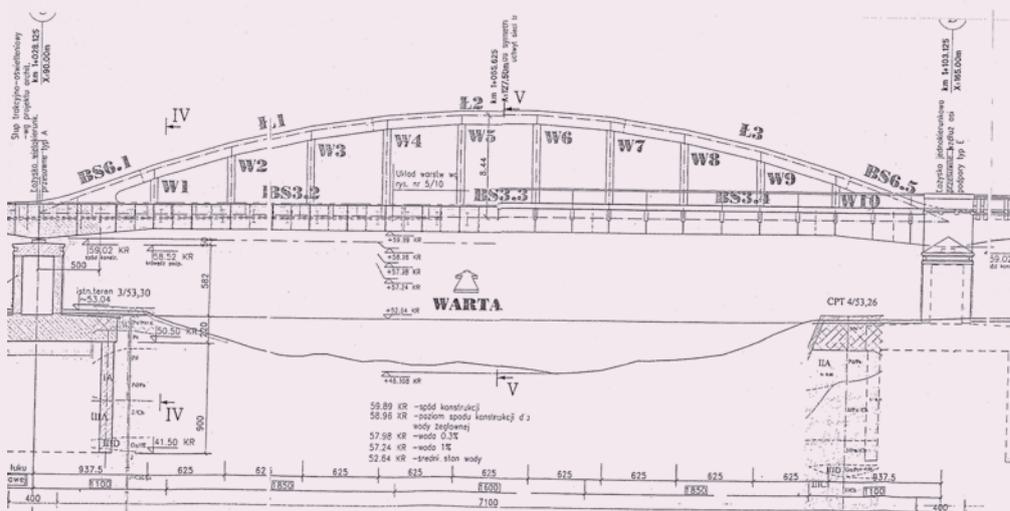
coupe longitudinale de la travée centrale – Source : Colas
